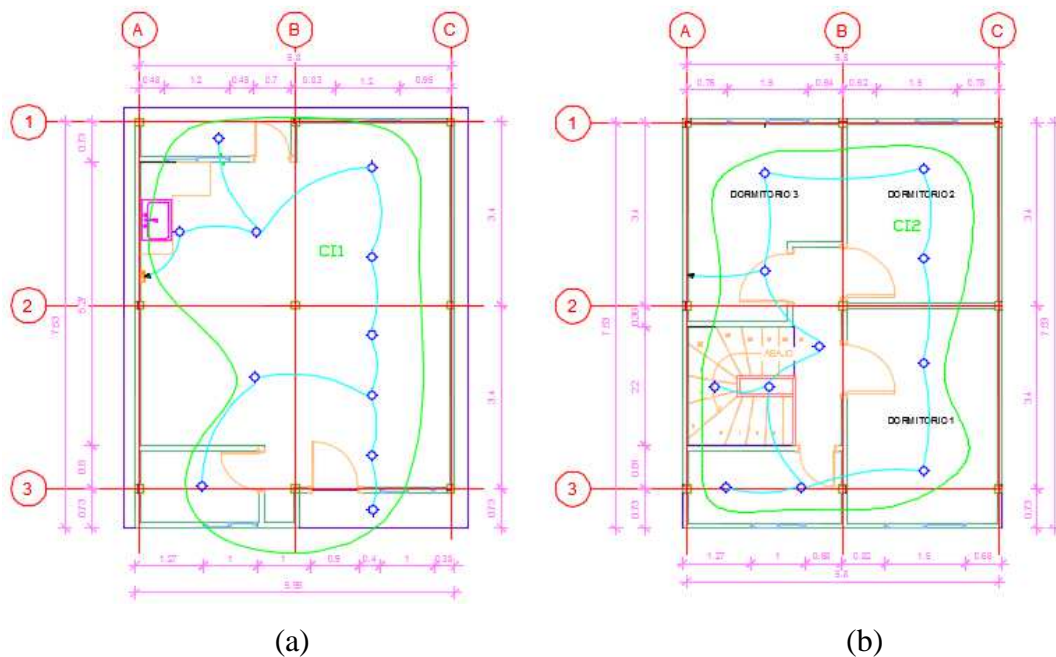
Circuito de Iluminación planta baja (a) y segunda planta (b)
